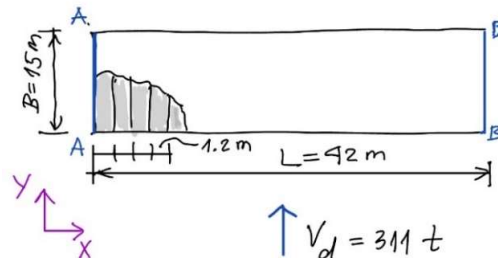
Схема плана перекрытия на отм. +7.2 м - расчетная сейсмическая сила по направлению Y
